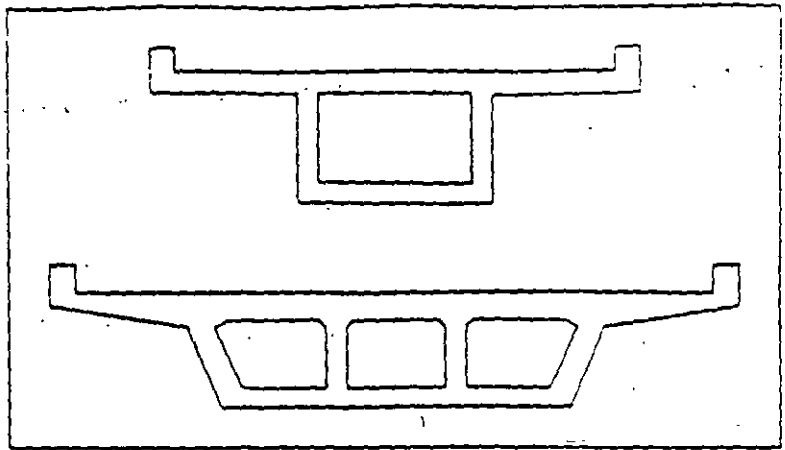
Sección transversal, tipo 30. Trabe cajon. 1 cajon
